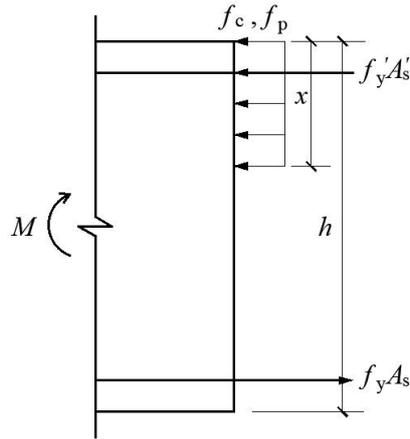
3D 打印模板配筋混凝土构件正截面受弯承载力计算示意图
